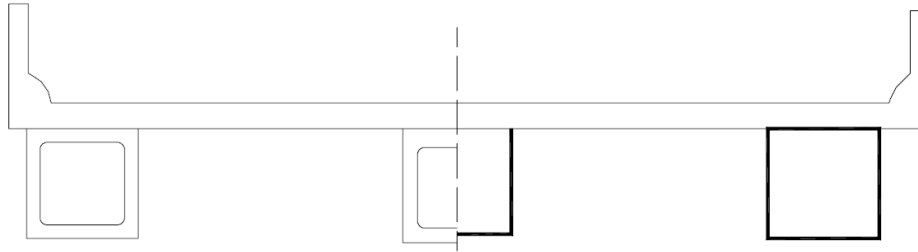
Sección transversal de puente con vigas cajón cerradas de acero o concreto reforzado prefabricado (AASHTO, 2007)
